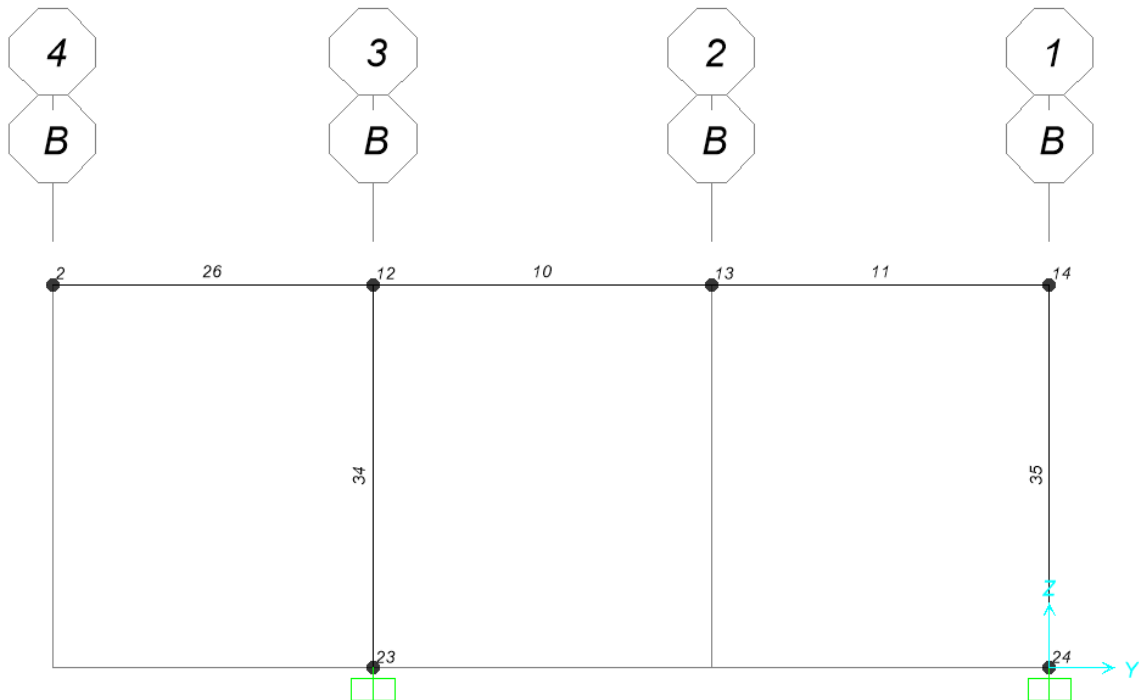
Vista in sezione modello struttura in elevazione –Filo B - numerazione elementi frame e joint
